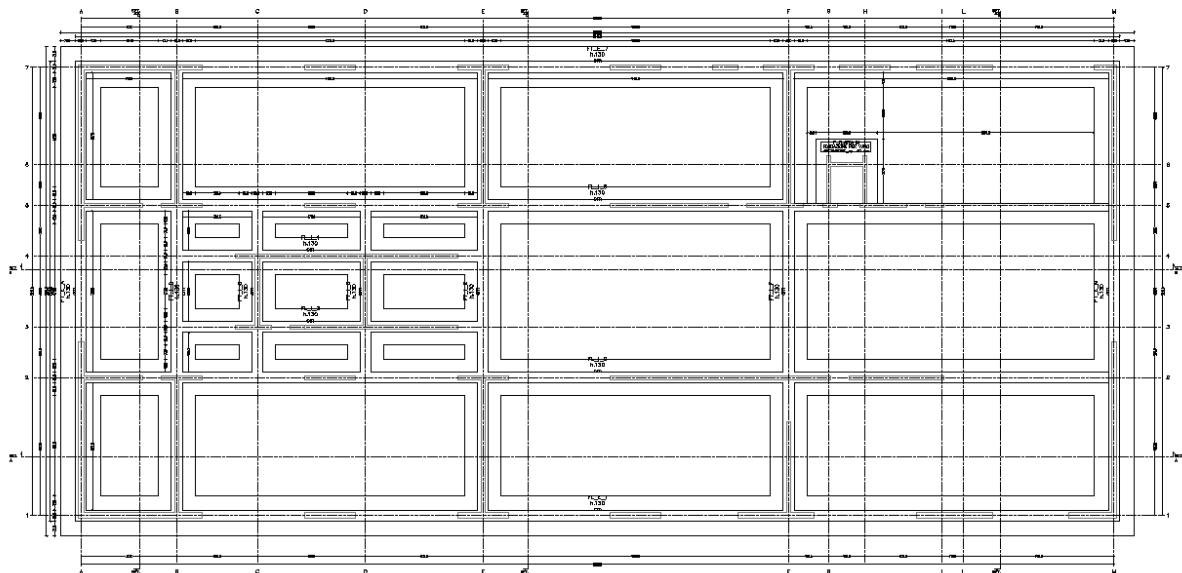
Pianta setti p.1 scuola: strutture in progetto
